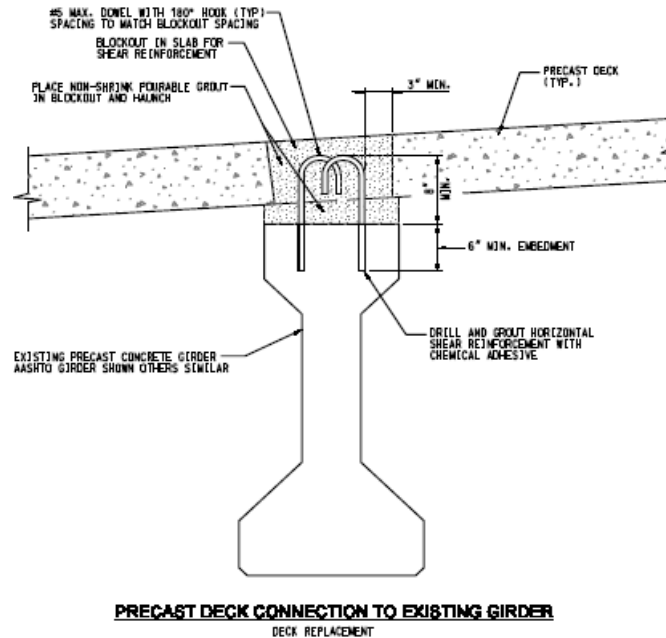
Connexion avec une poutre en béton pour les structures existantes (Culmo, 2009)
